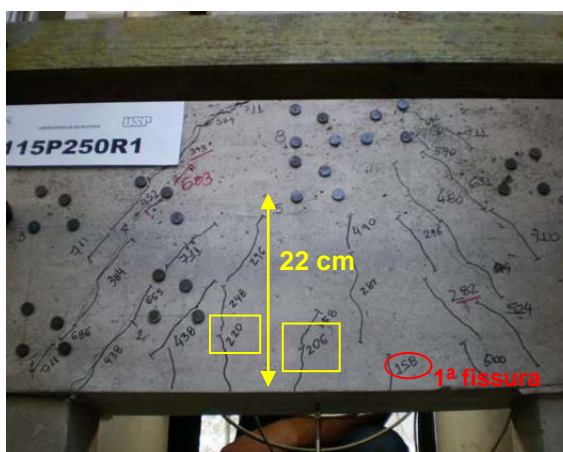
Fissuras iniciais no modelo B115P250R1
